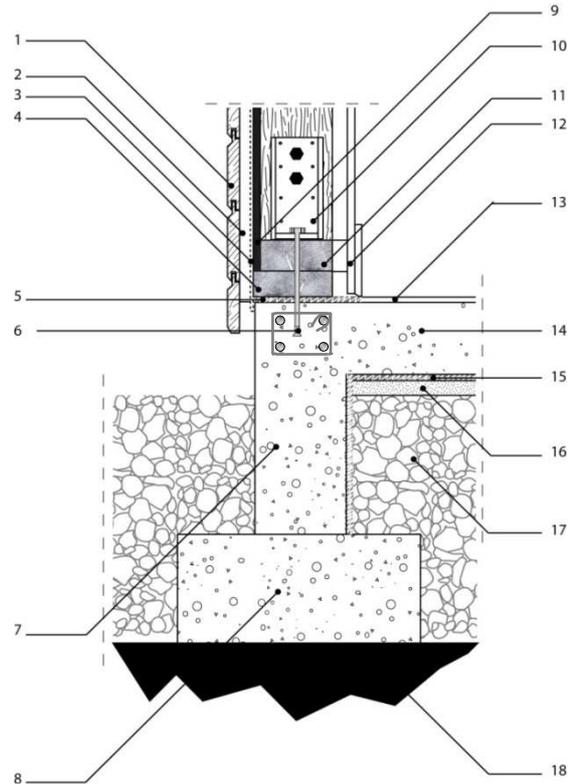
Coupe verticale de principe : Détail d'ancrage d'une lisse basse de mur extérieur sur semelles béton - panneaux de contreventement murs VT
